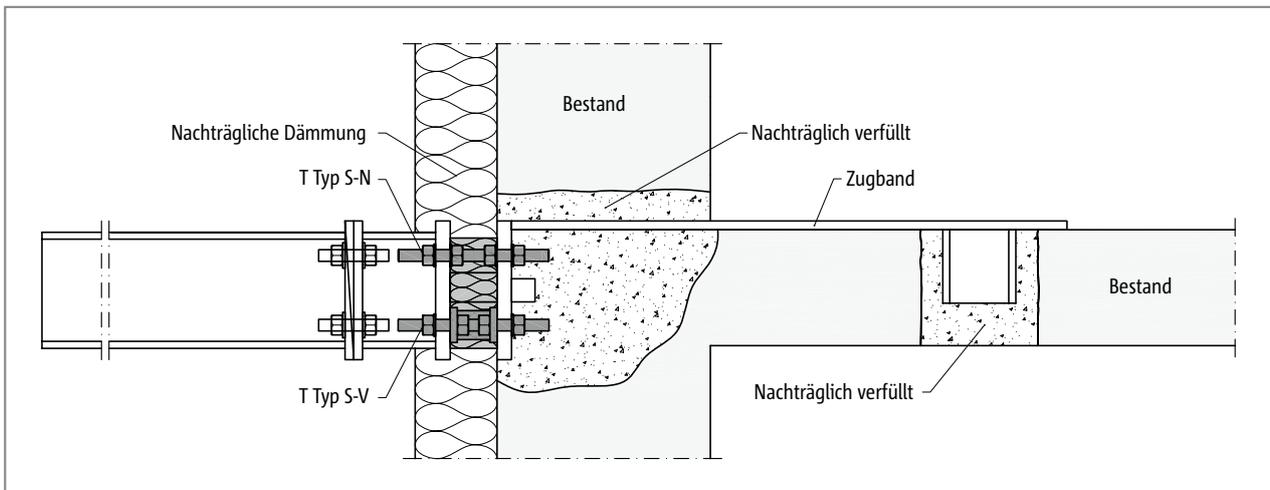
Schöck Isokorb® T Typ S-N und T Typ S-V: Nachträglicher Stahlbalkon mit Adapter, frei auskragend; mit Zugband angeschlossen an bestehende Stahlbetondecke
